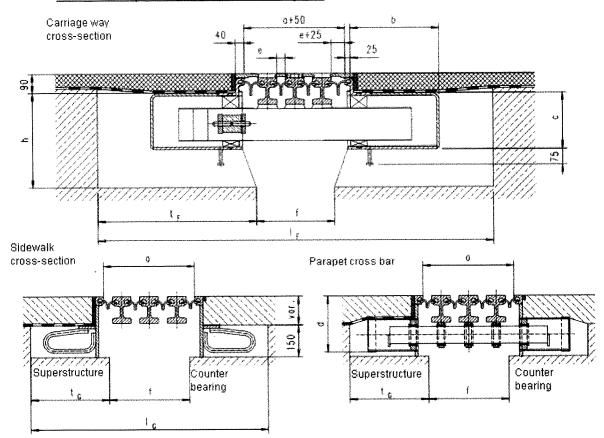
Coupe transversale - Zone chaussée et trottoir
